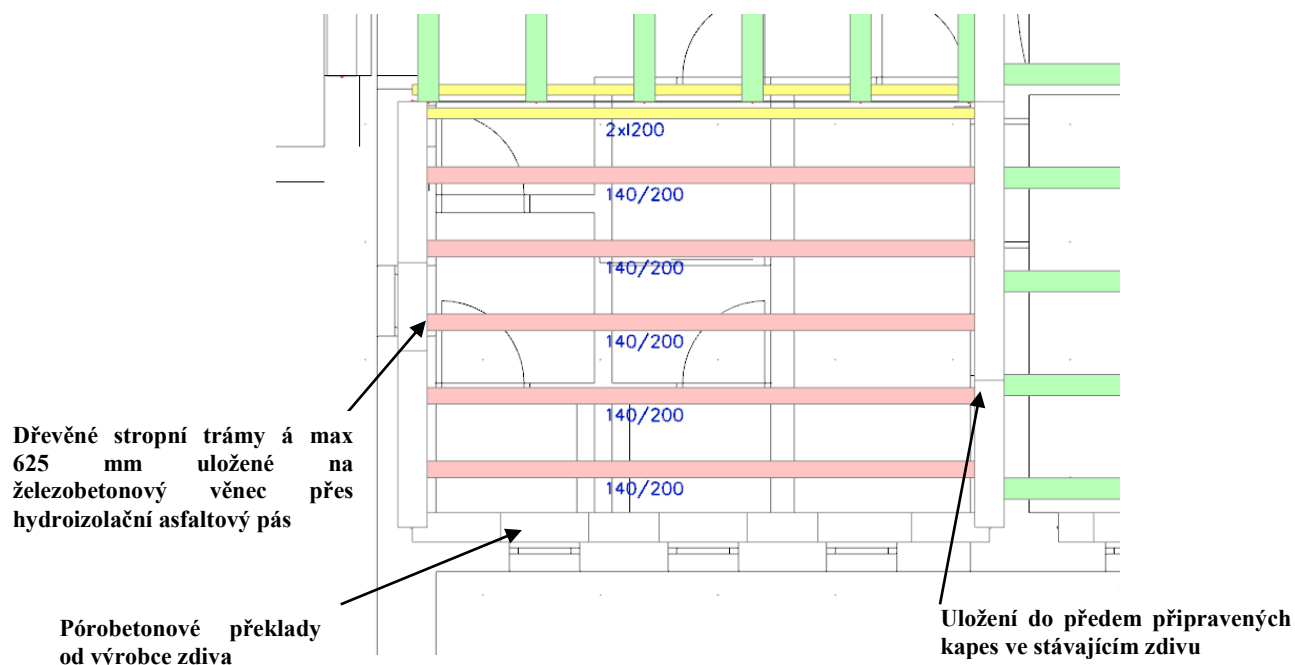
Půdorys stropní konstrukce nad 1. PP
